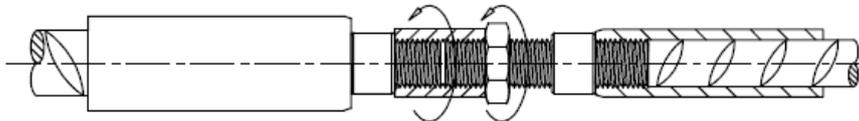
DISTANZÜBERBRÜCKENDE POSITIONSVERBINDUNG (PII)
